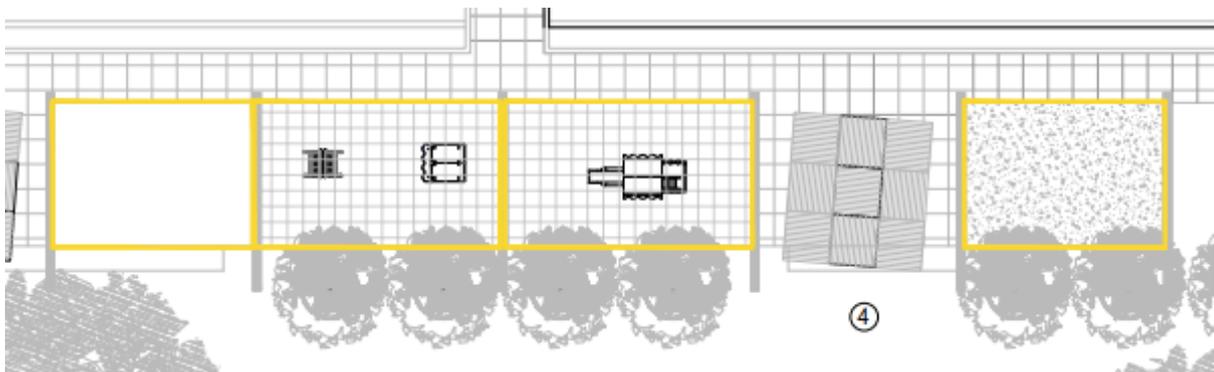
Planta da situação existente (PI 4) | Fonte: autora, 2023 | sem escala
